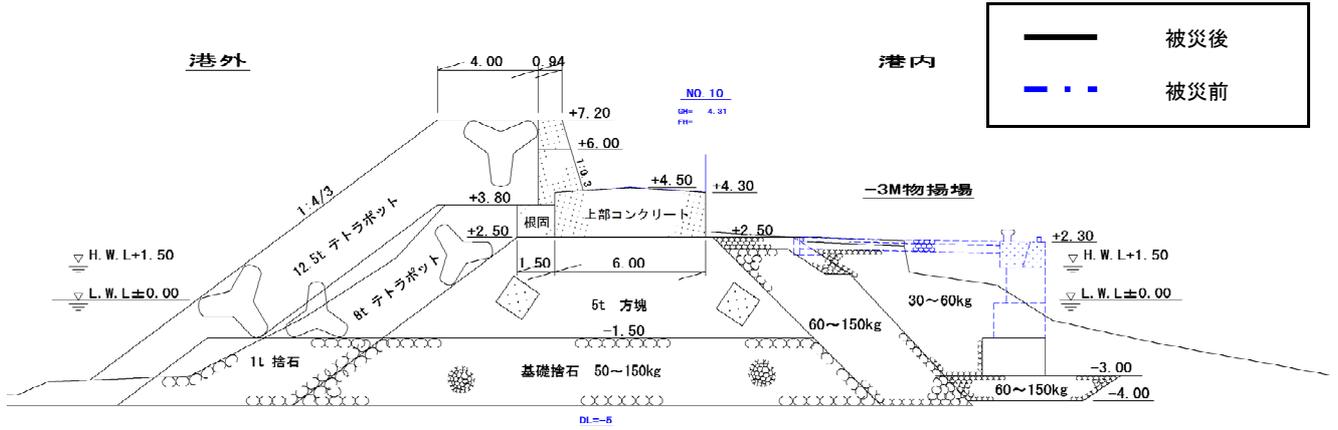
No.25 大洗港区_第1埠頭地区A物揚場 (-3m) の断面図 (被災後)
